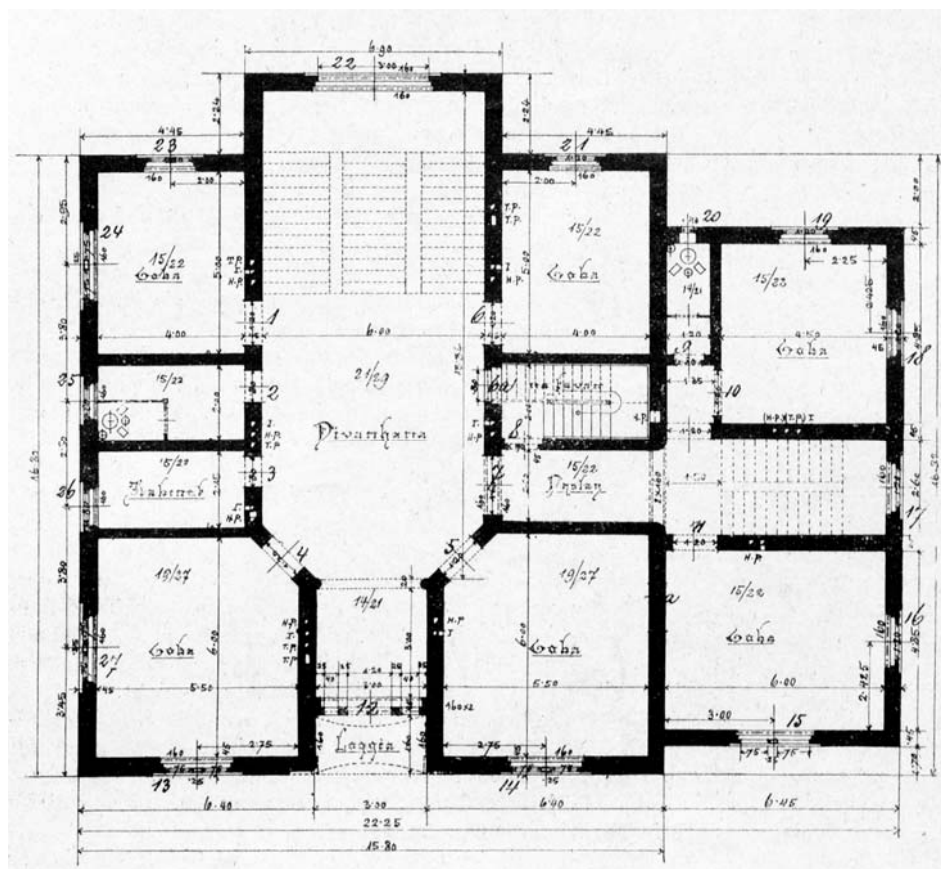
Sarajevo, Einfamilienhaus Sadikbeg-Fadilpašić, Grundriss Obergeschoss
